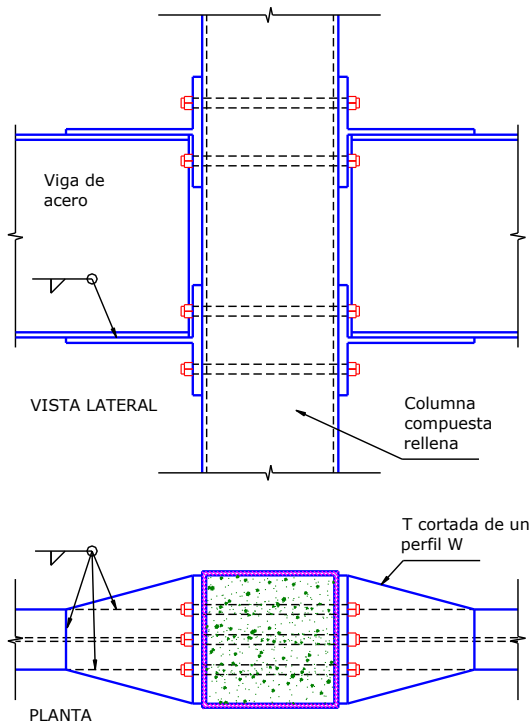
Conexión de una viga de acero con una columna compuesta rellena, con interrupción de la continuidad de la viga.
